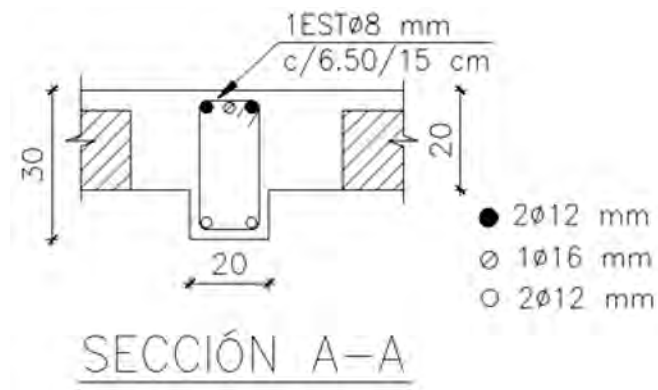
Corte transversal de viga eje 1, incluye estribos
